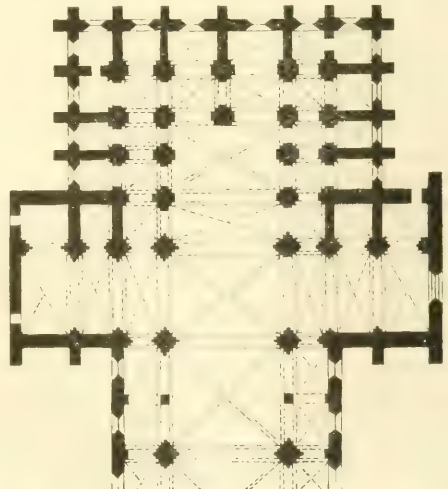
Grundriss von Ebrach. (Nach v. Quast.)
